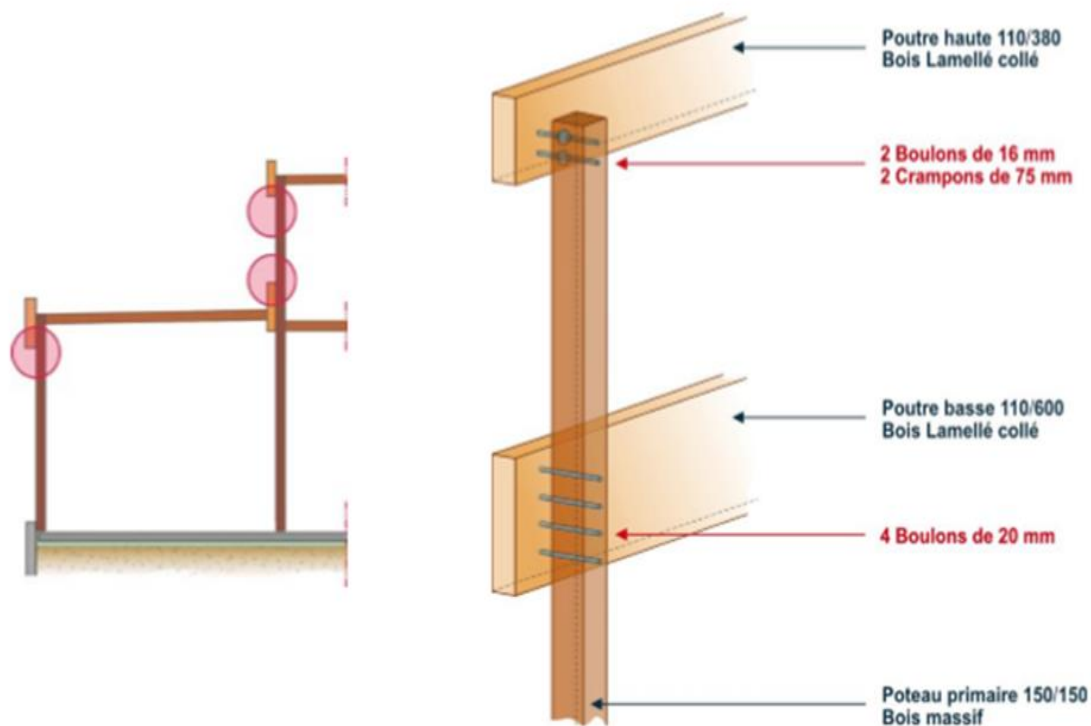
détail d'assemblages poteaux\poutres en bois,
